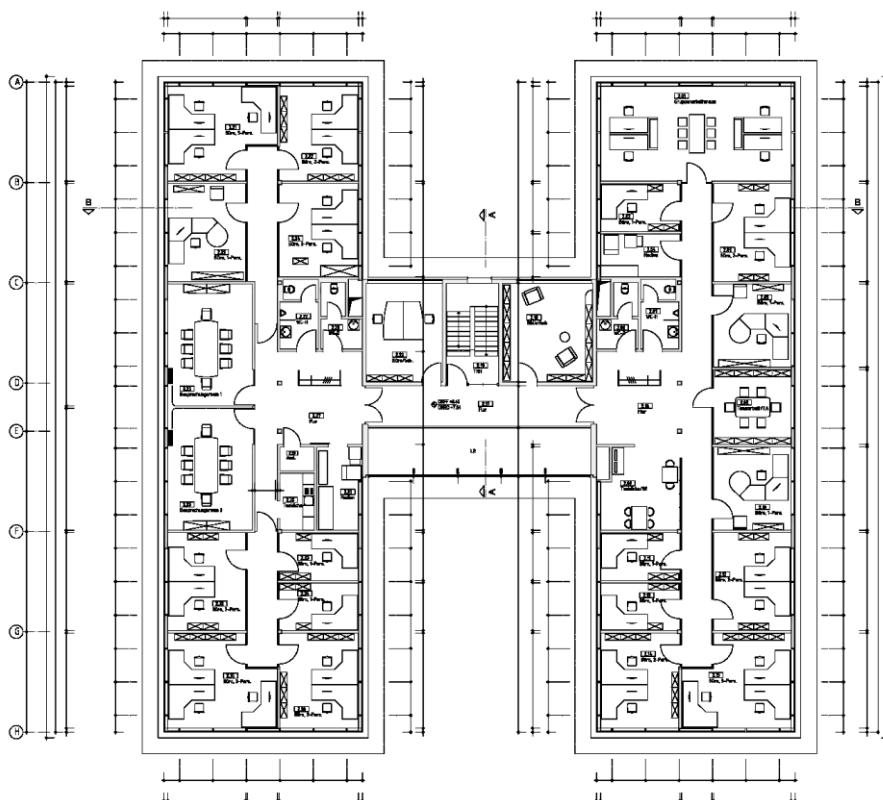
Grundriss des geplanten 2. Obergeschosses
